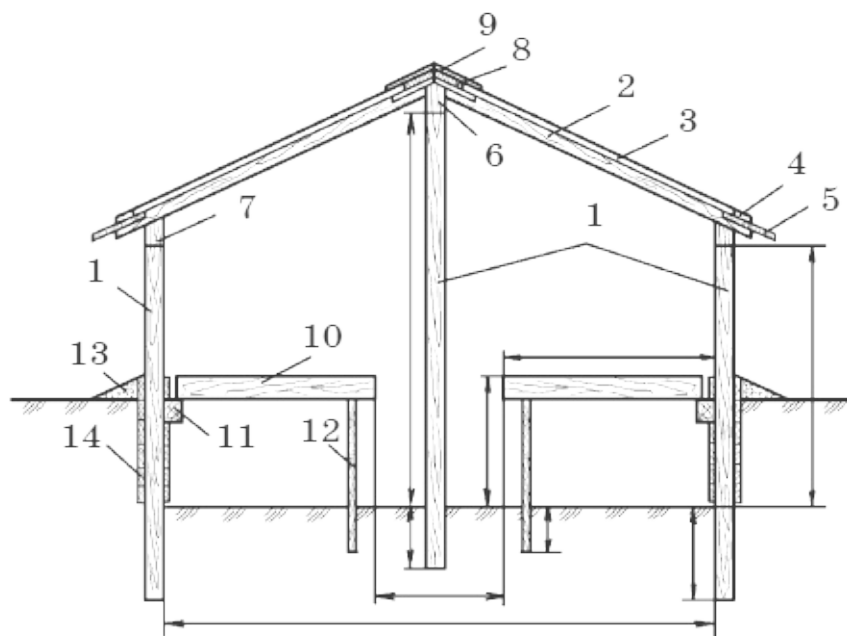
Весенняя двускатная теплица: 1 — столбы; 2 — стропила; 3 — парниковые рамы; 4 — опорная доска для упора рам; 5 — слив; 6 — коньковый брус; 7 — обвязочный брус; 8 — доска; 9 — козырек из кровельного железа; 10 — стеллаж; 11 — опорный брус; 12 — стойка стеллажа; 13 — земляная отсыпка; 14 — обшивка стен
